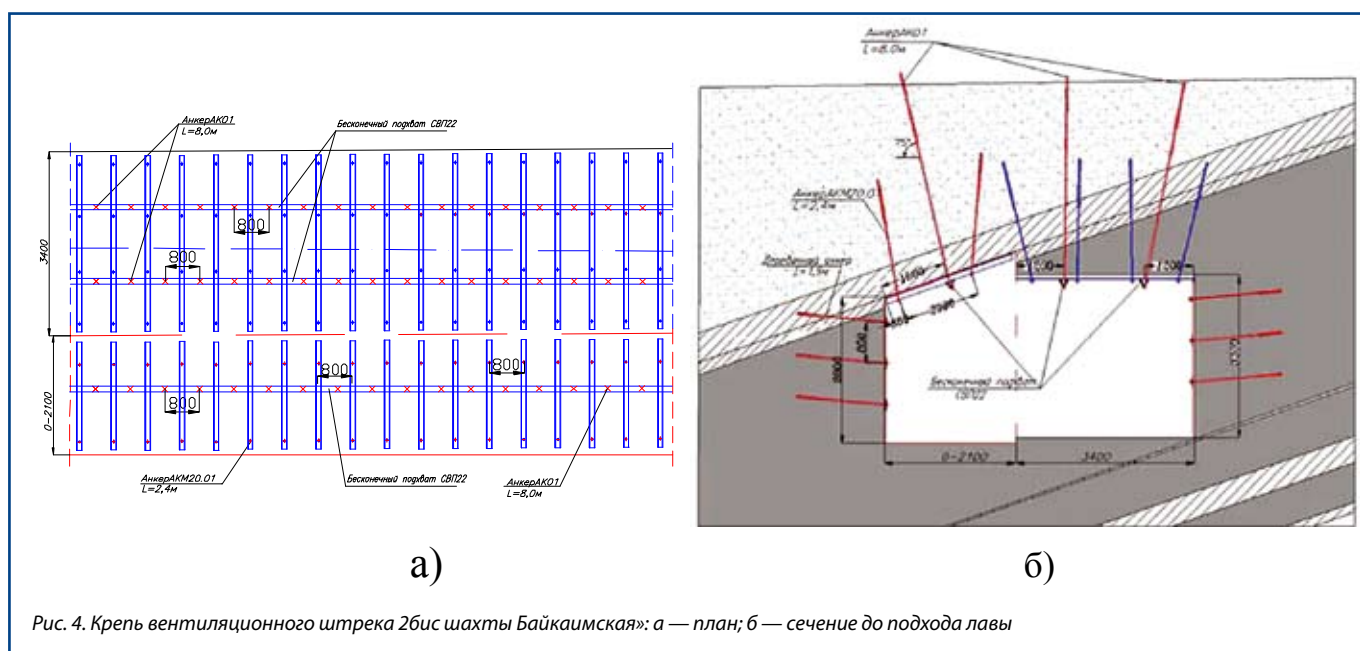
Крепь вентиляционного штрека 2бис шахты Байкаимская: а — план; б — сечение до подхода лавы
